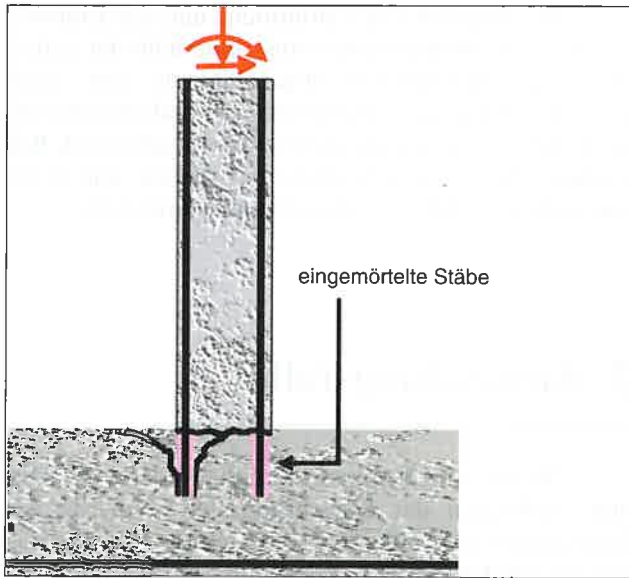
Anschluss einer Stahlbetonstütze an ein Fundament ohne Anschlussbewehrung bei überwiegender Momentenbeanspruchung. Anschluss nicht zulässig
